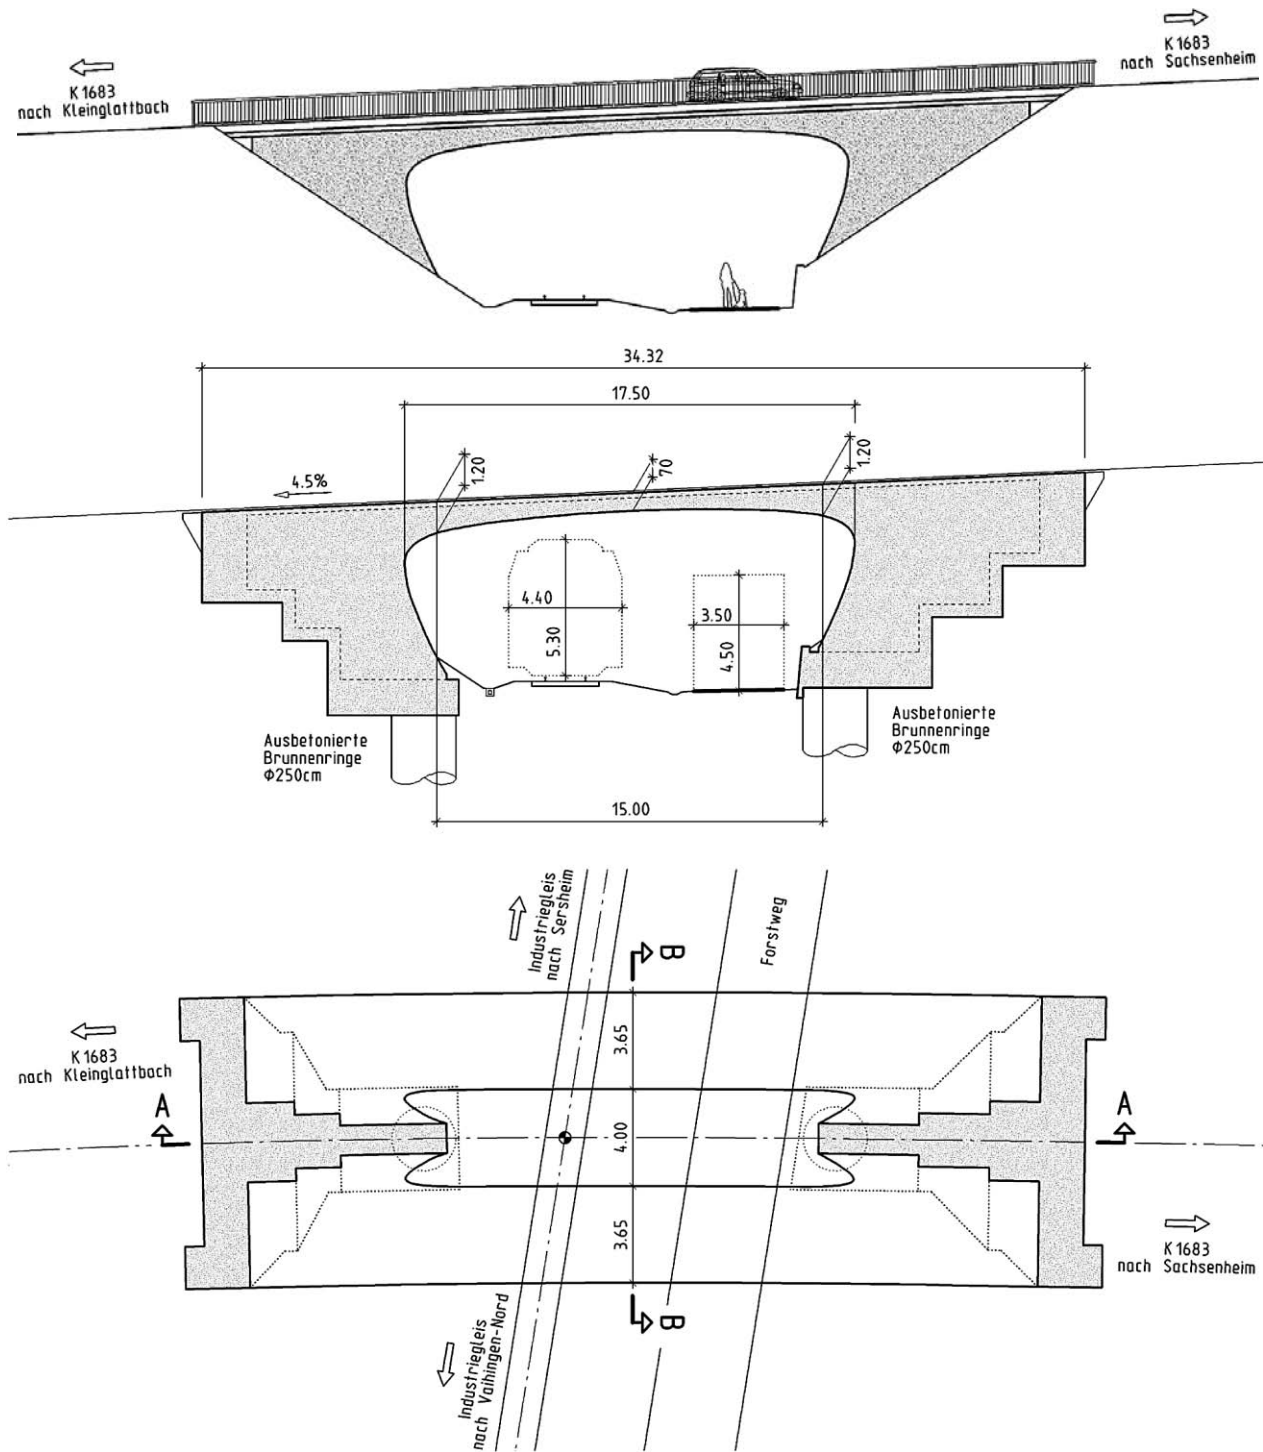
Bauwerk 1, Sersheim: Längsansicht, Längsschnitt A-A und Grundriß
